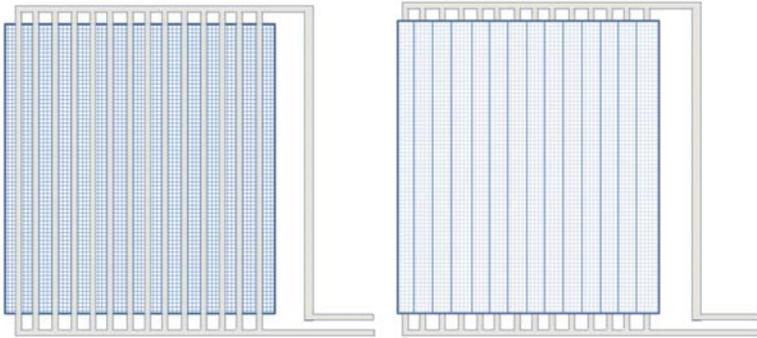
Thermisch aktive Wandsysteme; links: Typ 1, Gewebe mit integrierten Schläuchen und den Anschlussrohren, rechts: Typ 2, beschichtetes Gewebe mit ultraschallgeschweißten Kanälen und den Anschlussrohren
